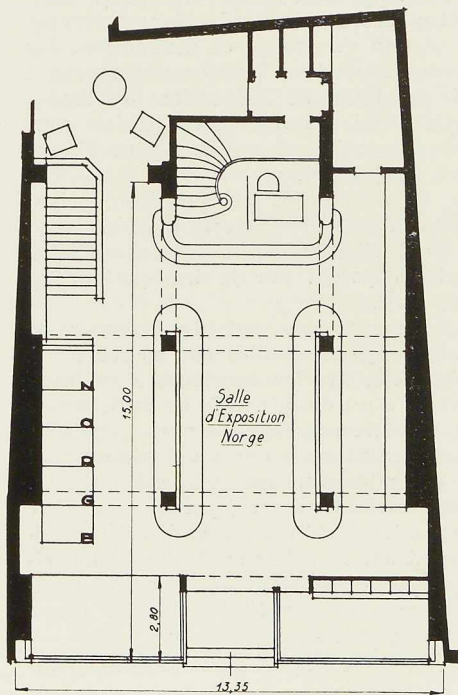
Vue en plan du rez-de-chaussée comprenant les magasins de vente.
